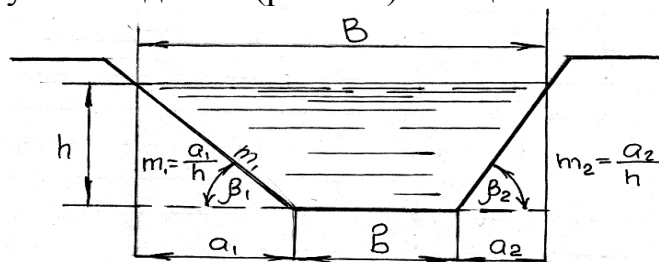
Основні елементи живого перерізу каналу при різній крутизні відкосів
